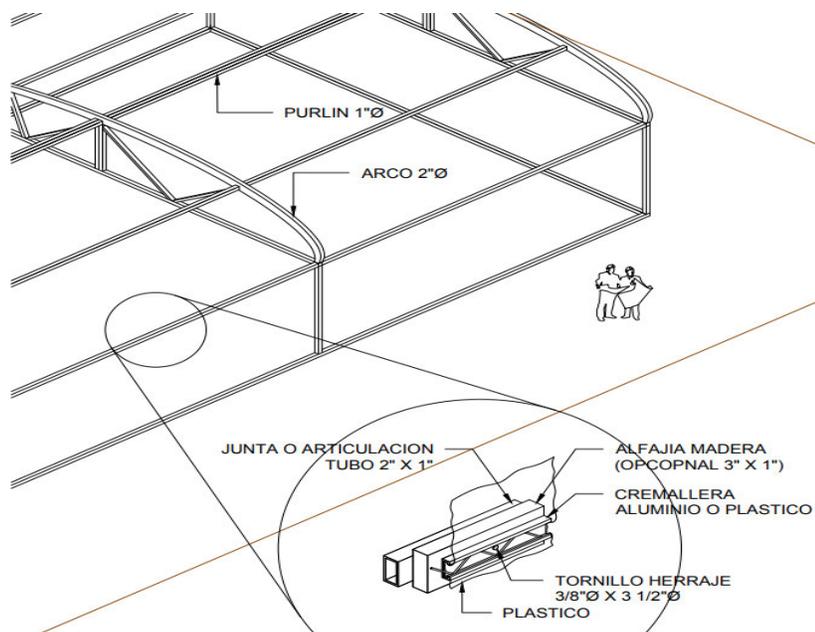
Detalles de la instalación de plásticos y cremallera de aluminio
